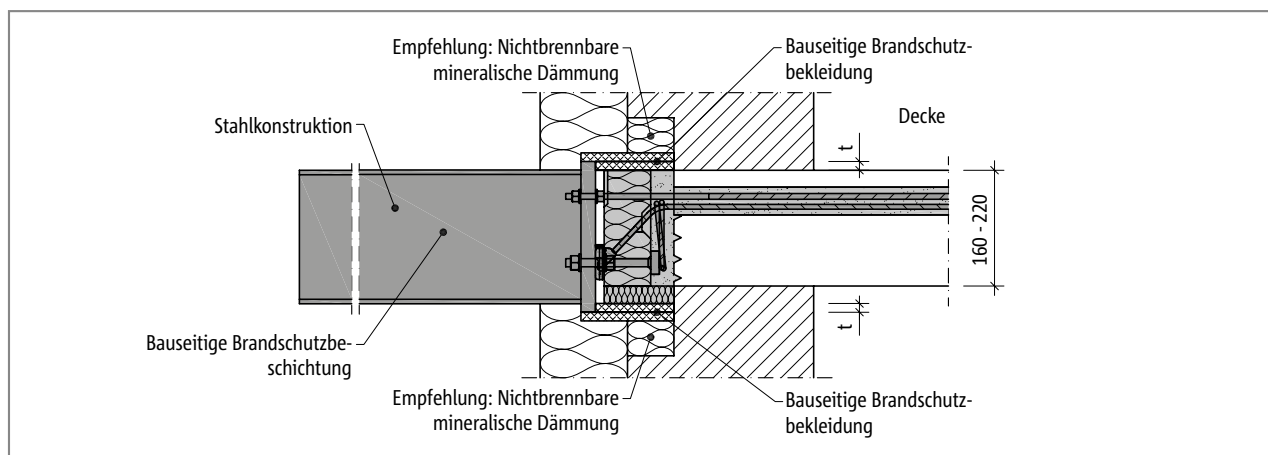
Schöck Isokorb® RT Typ SKP: Bauseitige Brandschutzbekleidung RT Typ SKP und brandschutzbeschichtete Stahlkonstruktion; Schnitt
